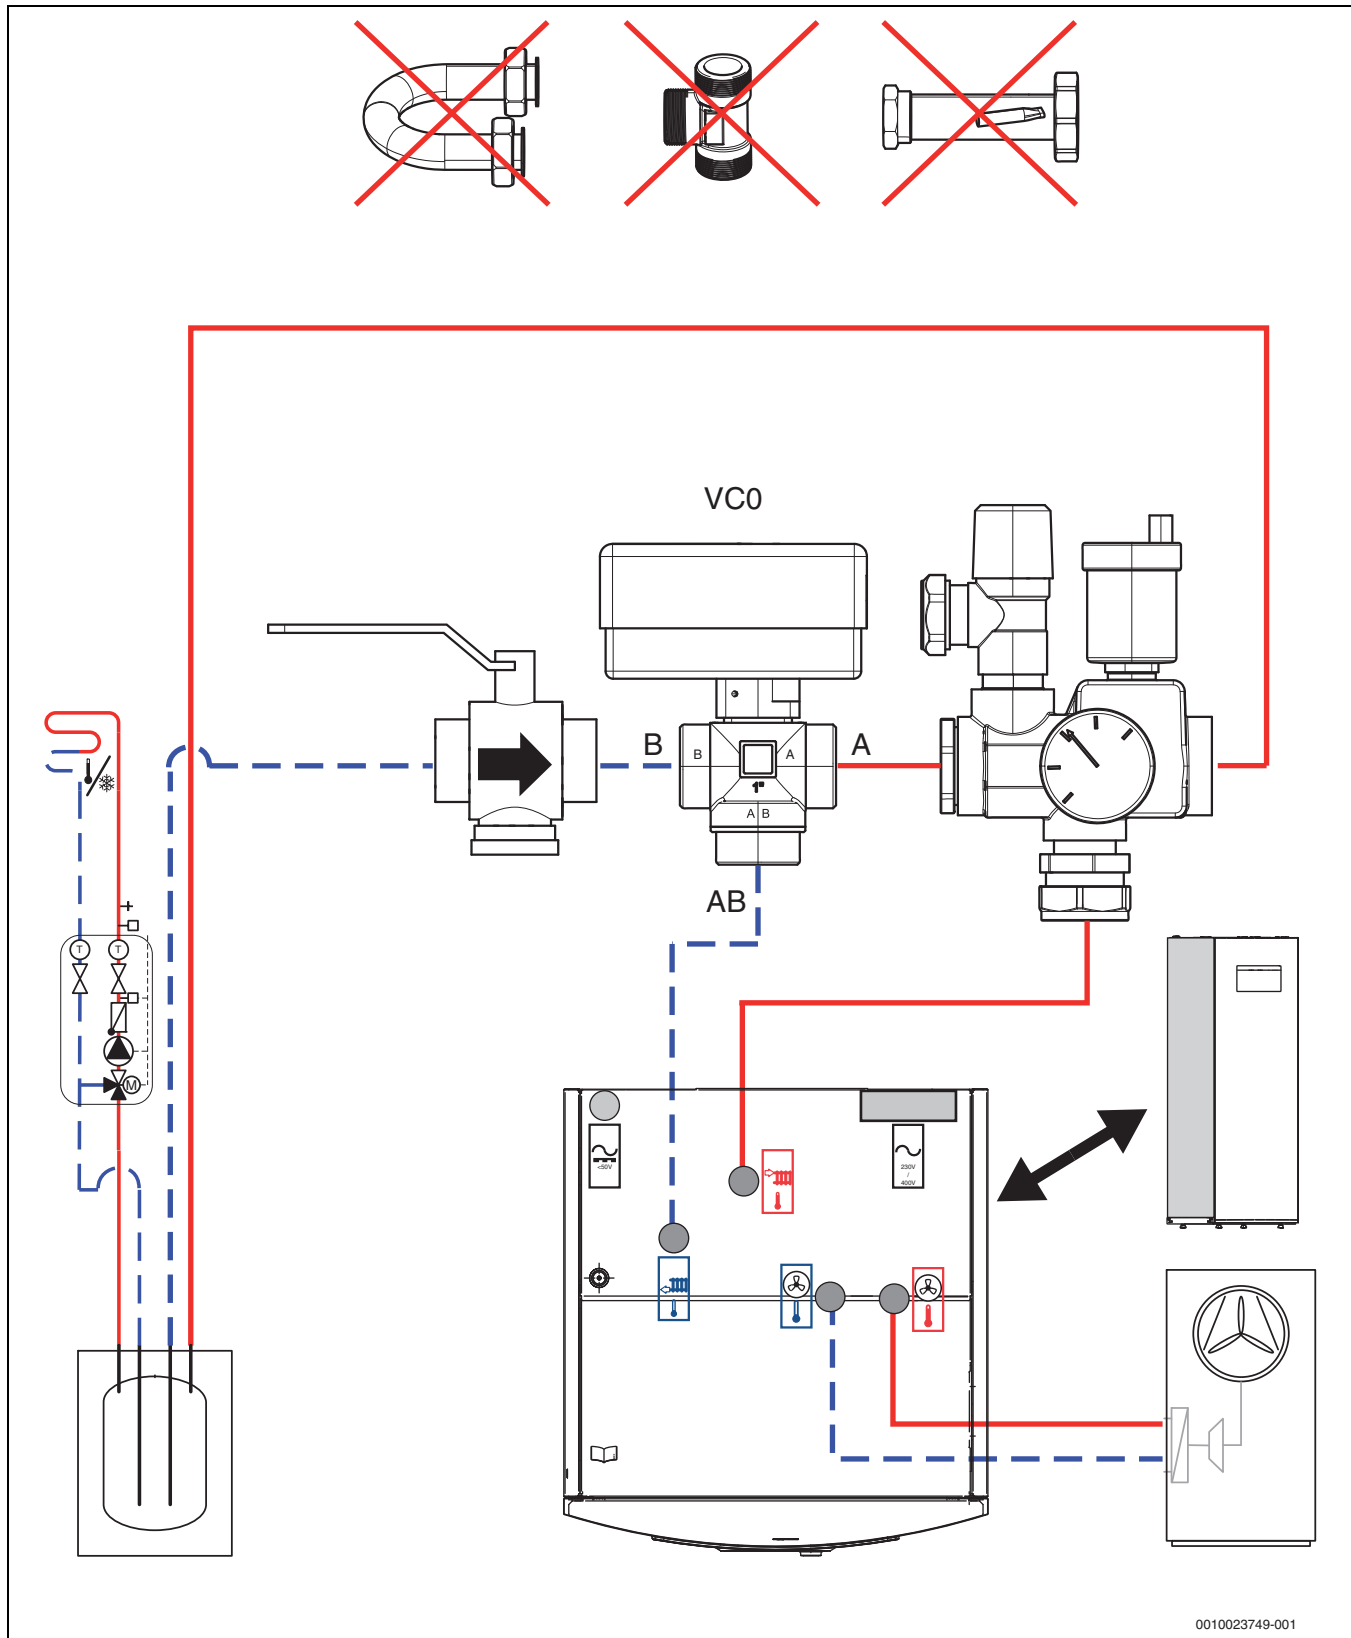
Exemplarische weergave voor de zwembadininstallatie
